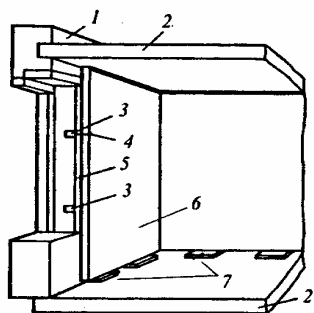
Облегченная кирпичная стена с теплоизоляционной панелью:
